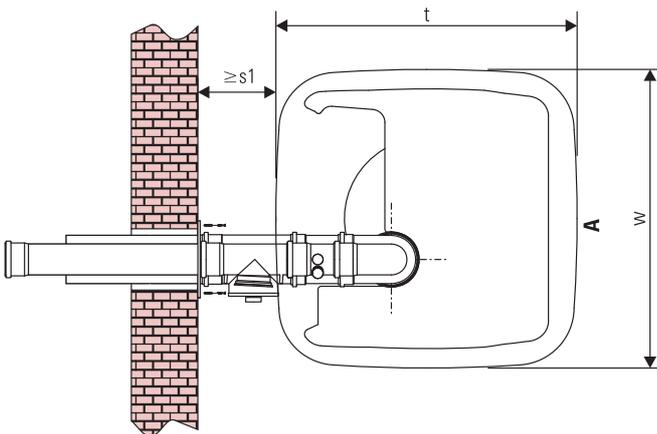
Vista dall'alto collegamento fumi GSU sul retro con SET H (v. sezione 3.5.3)
